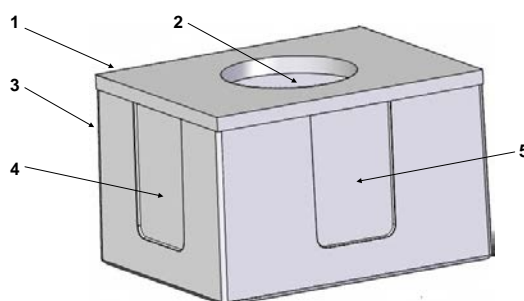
Элементы на колодце «ККСр-1-10(80)» (вибро) в сборе: 1 – плита перекрытия; 2 – круглое отверстие для люка; 3 - корпус; 4 – ниша на торцевой стене; 5 – ниша на боковой стене. Диаметр круглого отверстия для входного люка – 600 мм.
